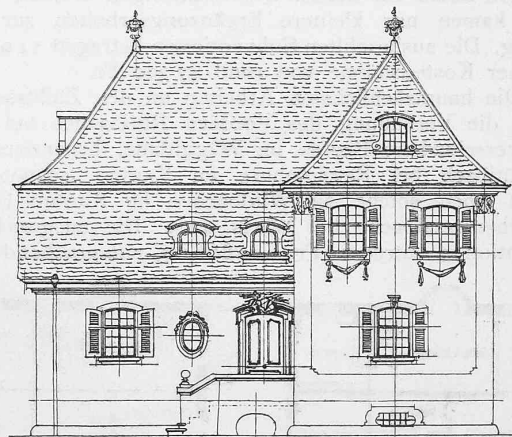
Façade sur la rue de la villa Lugeon. — Echelle 1 : 200.
